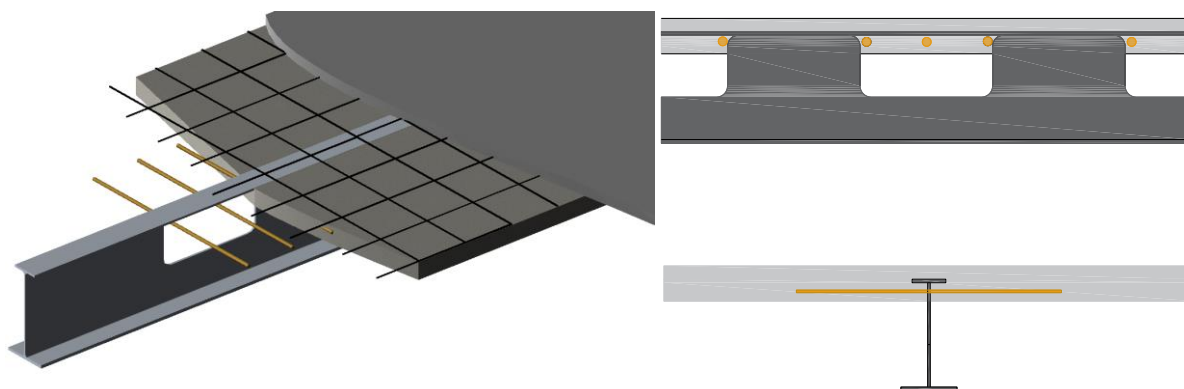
Detalhe da viga mista com as armaduras na laje de concreto
